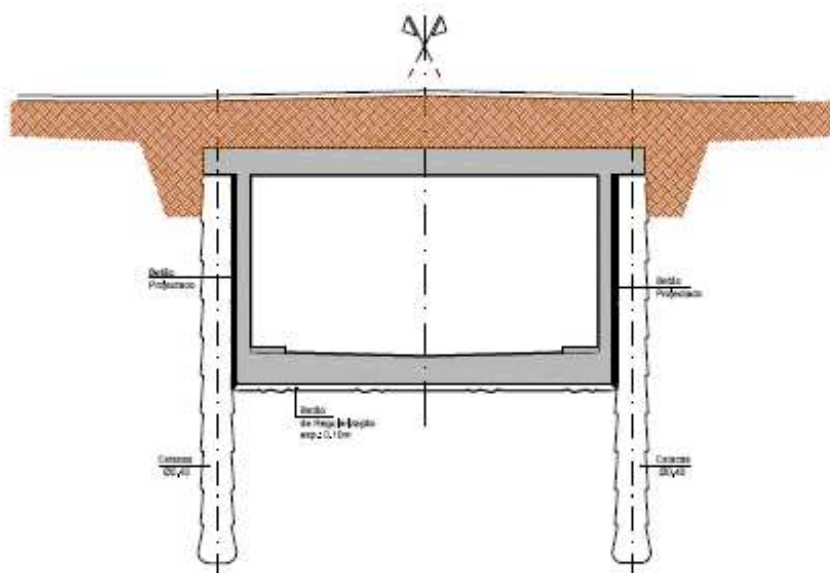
Fase 7 – Execução das paredes e laje inferior em betão
